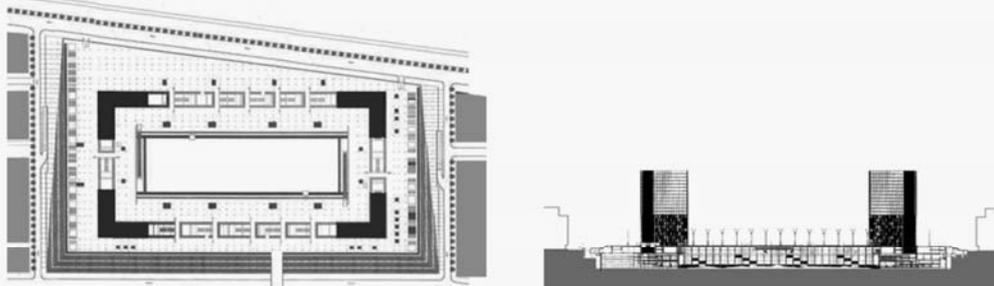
Planta baja y sección urbana de la Biblioteca. Fuente: Elaboración propia.
